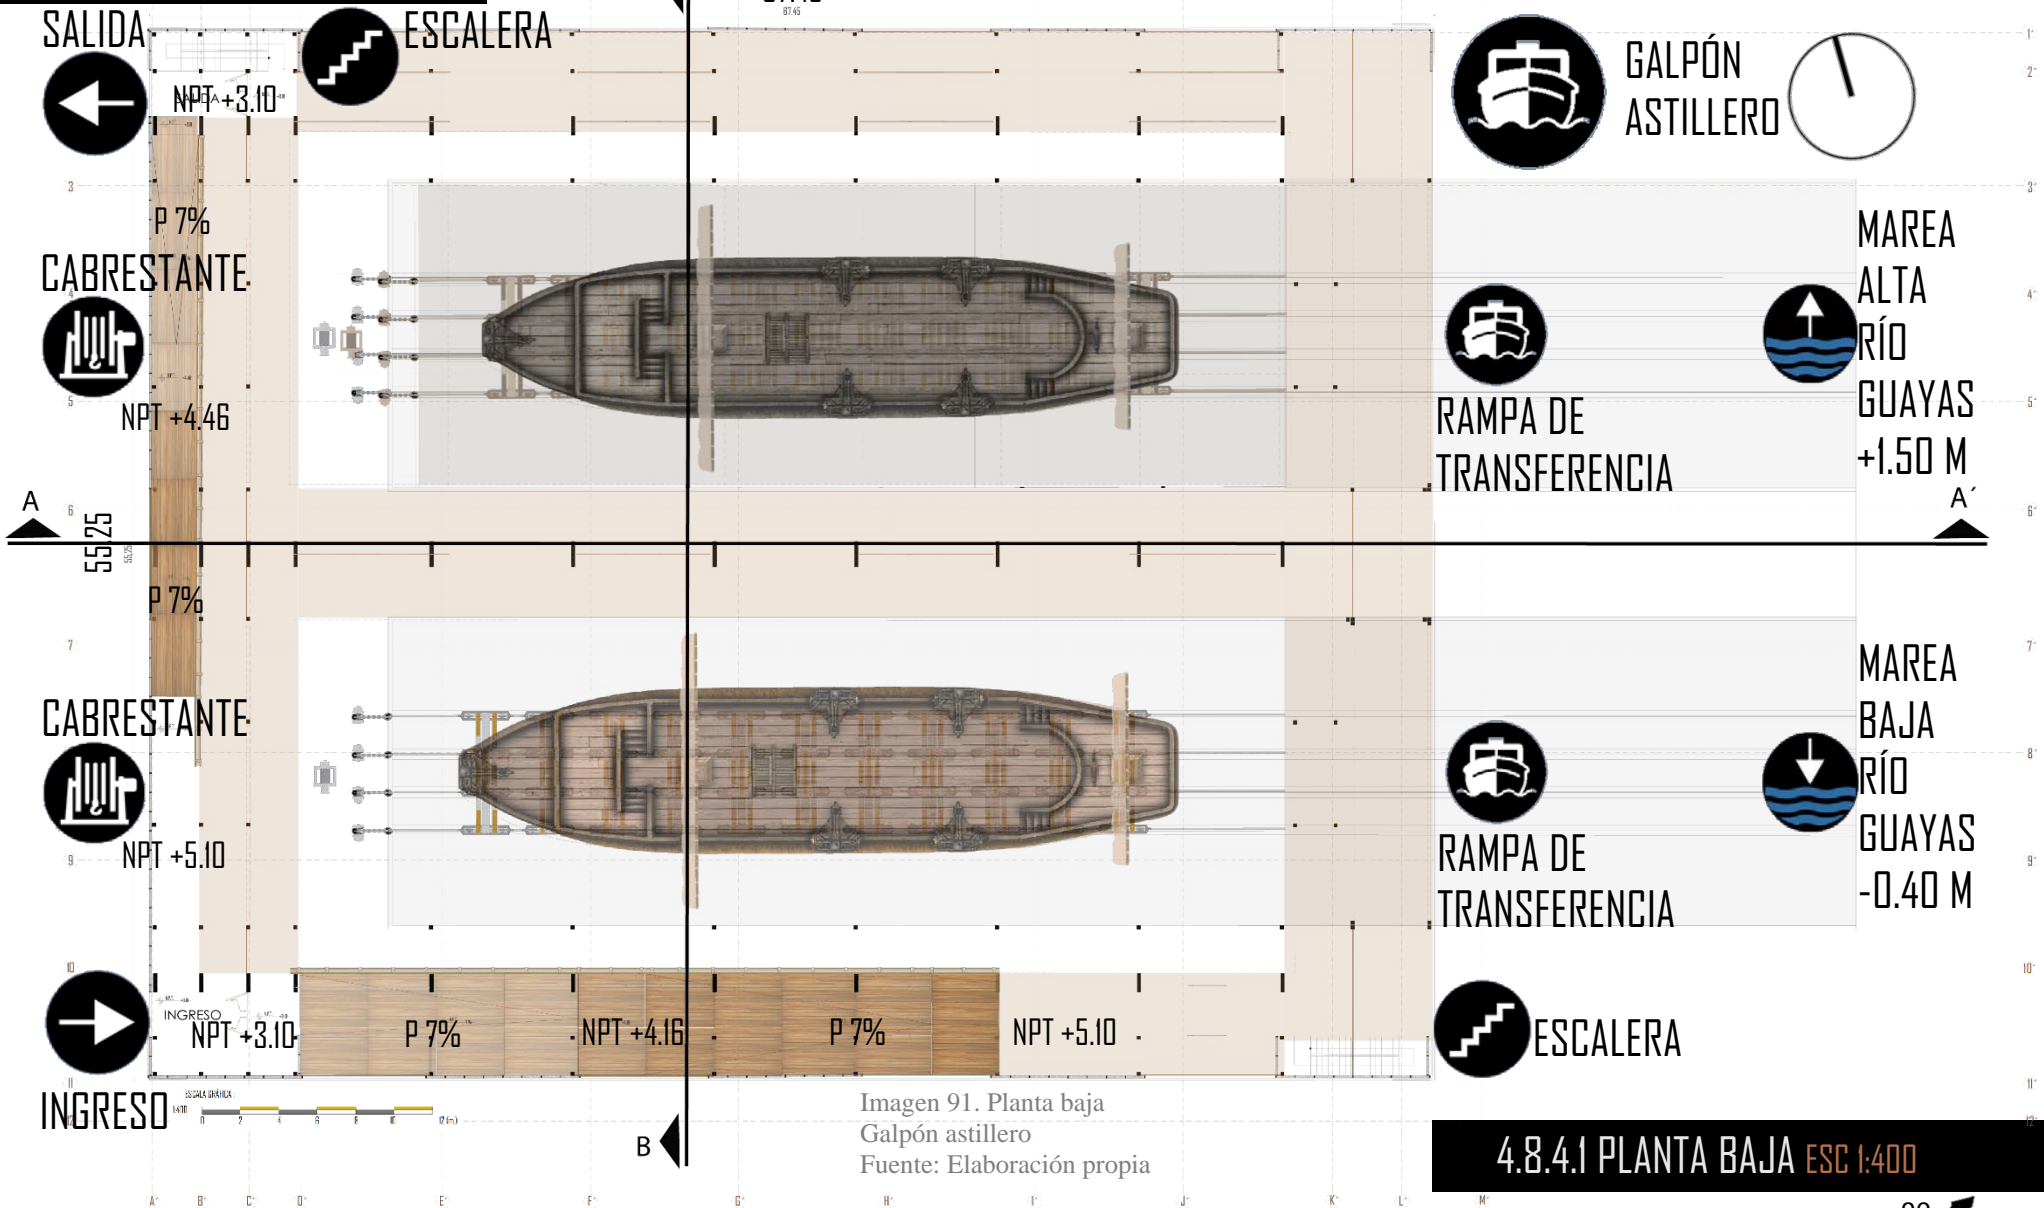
Planta baja Galpón astillero Fuente: Elaboración propia
